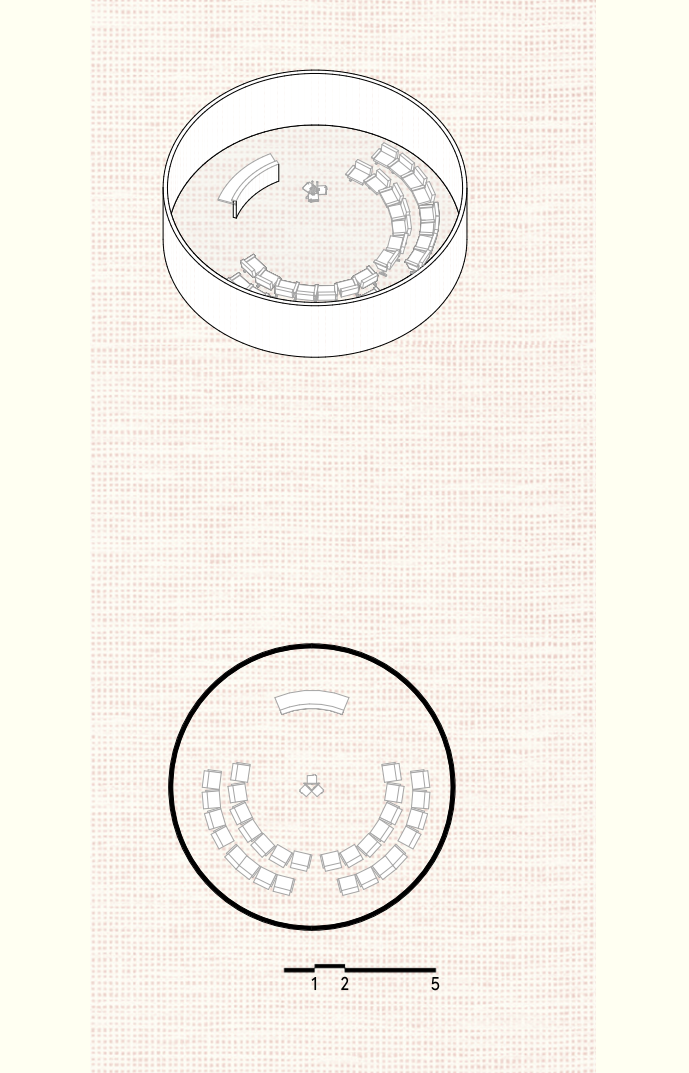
Holodeck, proposta de uma aula imersiva com layout livre.
